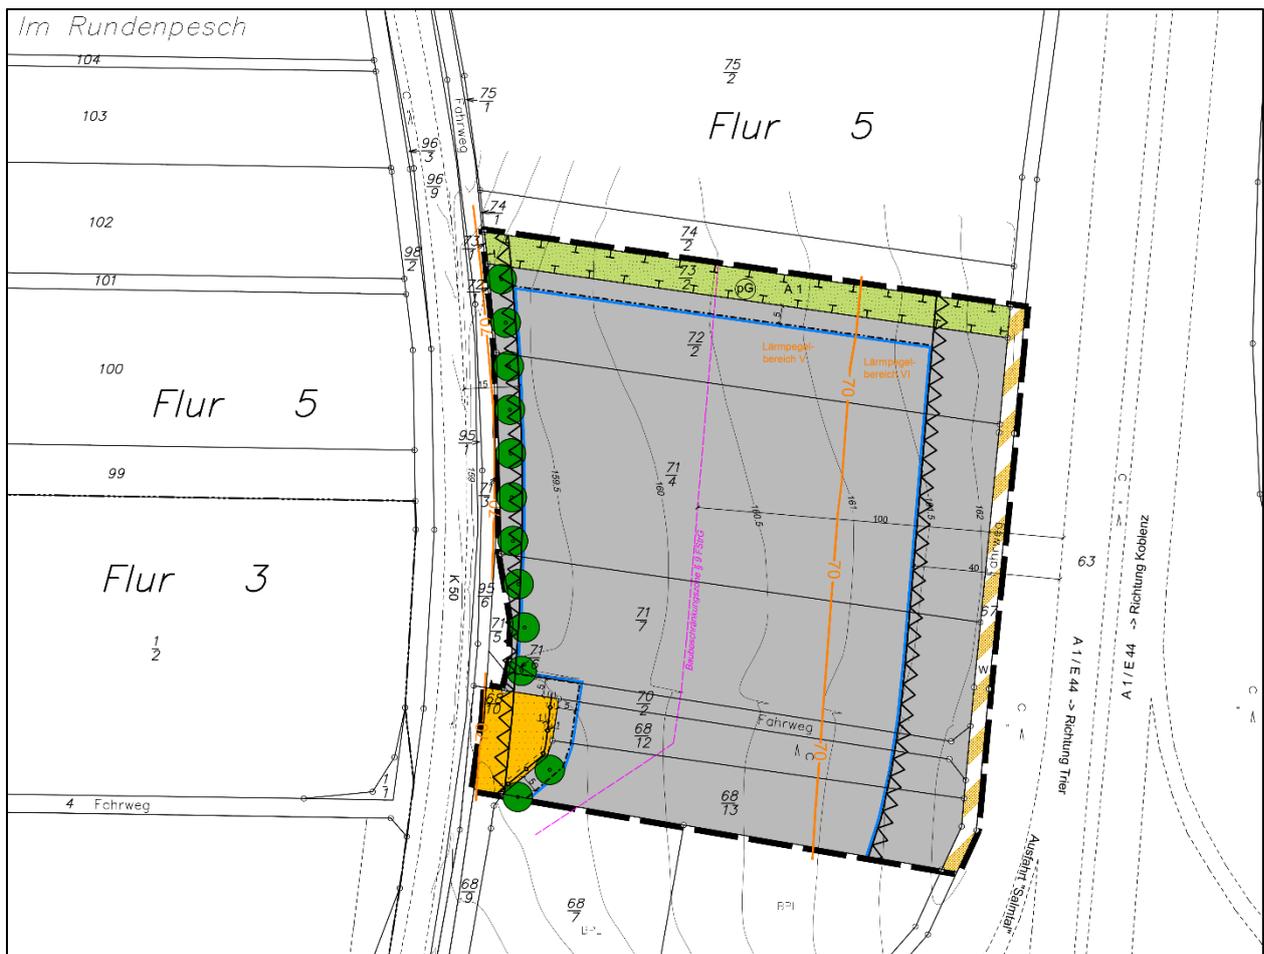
Bebauungsplan "Gewerbegebiet - 1. Erweiterung" (2011)
